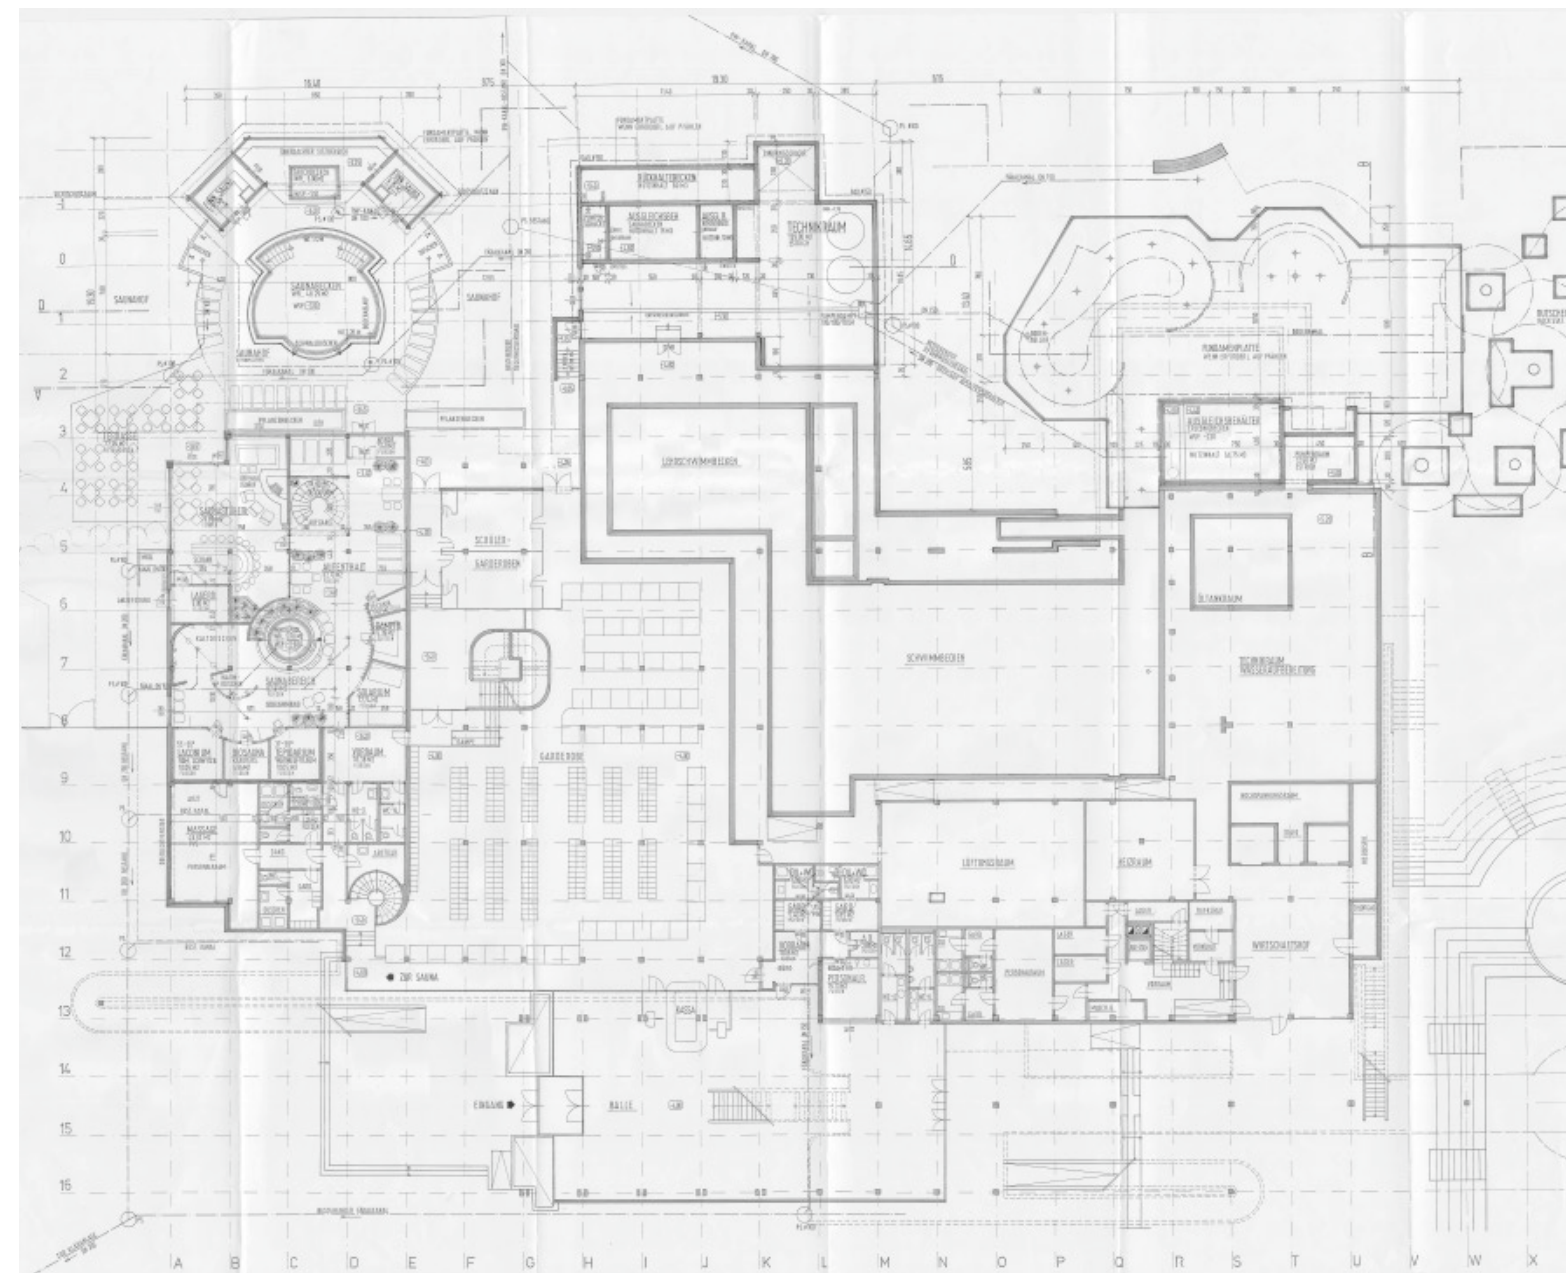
Grundriss Erdgeschoß, Einreichplan 1995
